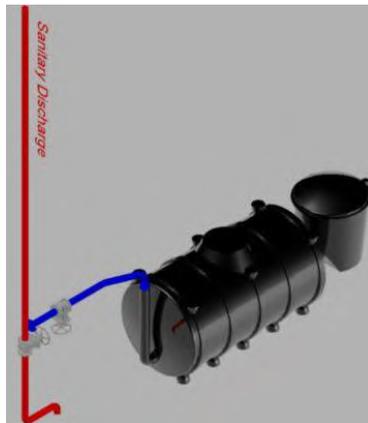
Layout Komponen Instalasi Biogas 3D
